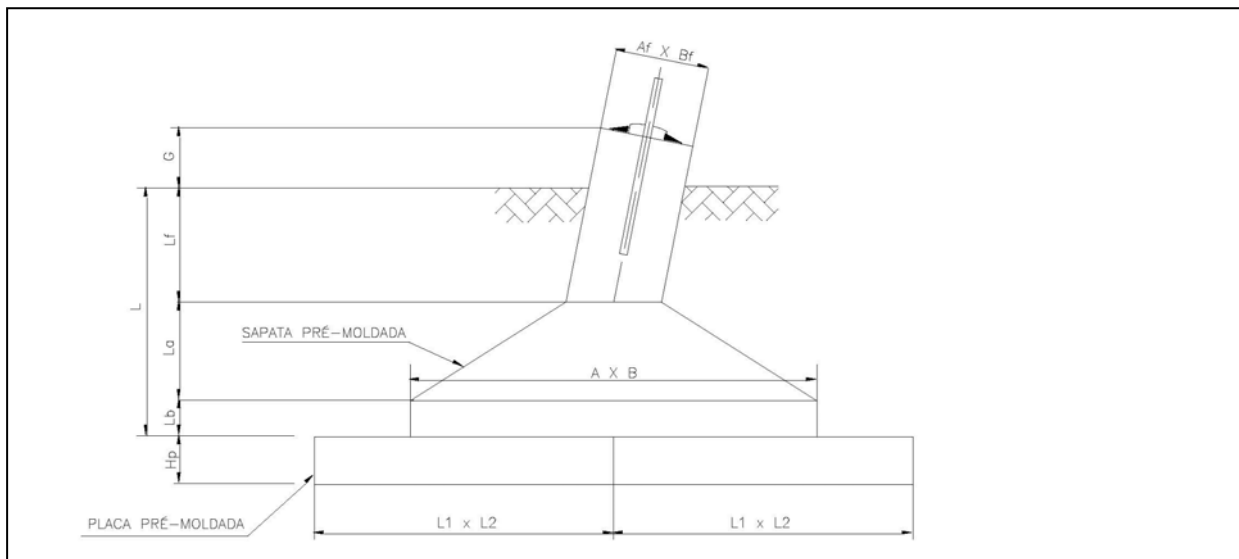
Mastros Tipo Sapata Pré-Moldada com ou sem Placa Pré-Moldada.
